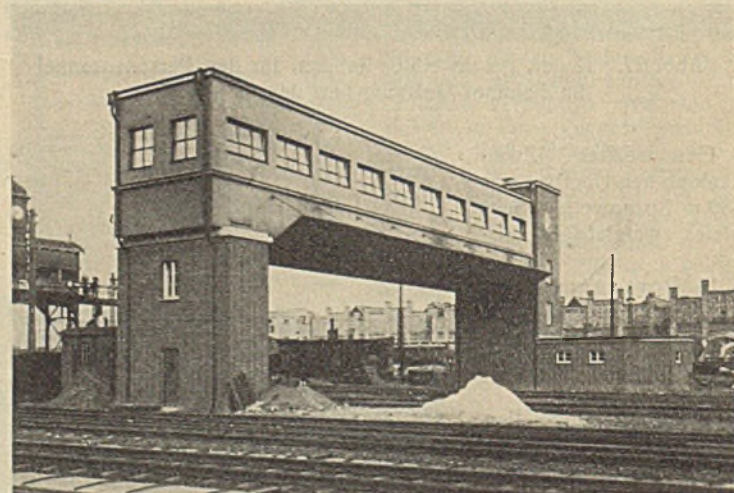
Neues Stellwerk auf Bahnhof Halle.
